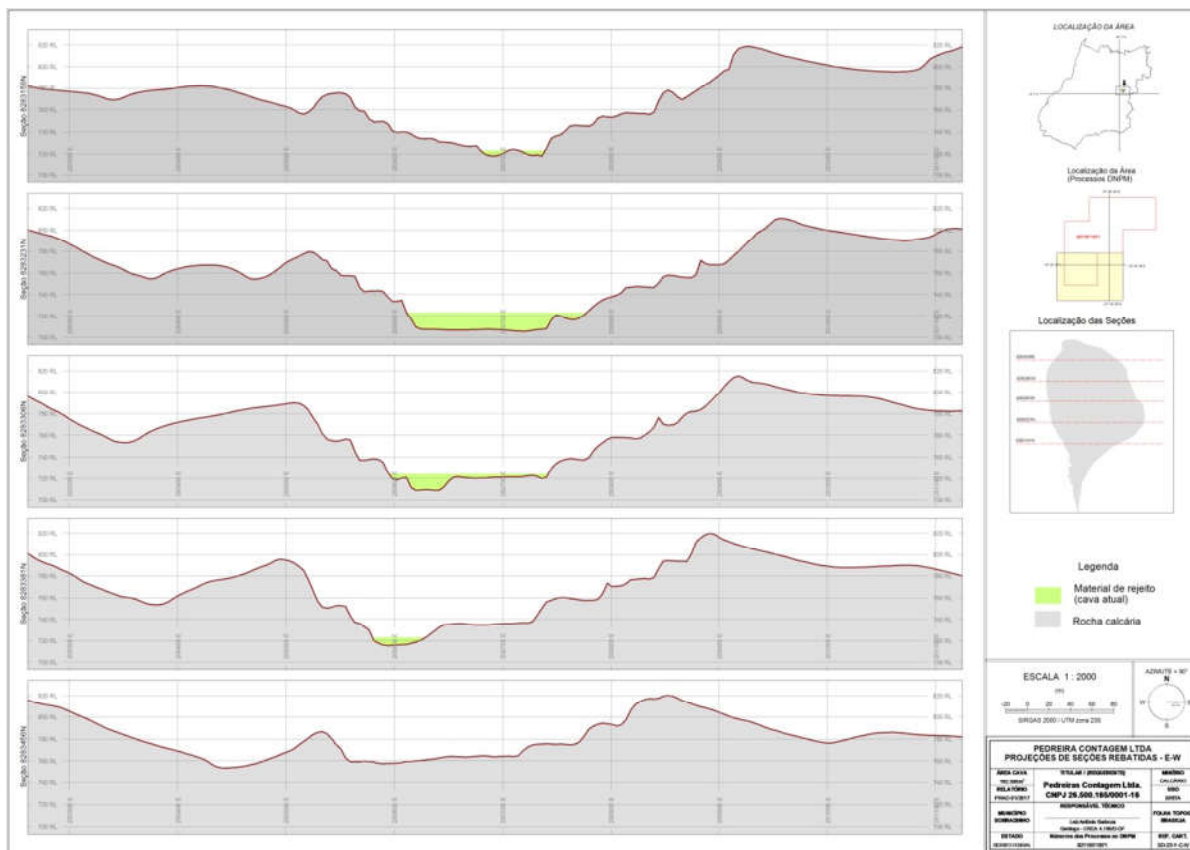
Figura: Processo DNPM 821.197/1971 – seções verticais rebatidas Oeste-Leste demonstrando preenchimento com estéril armazenado.
